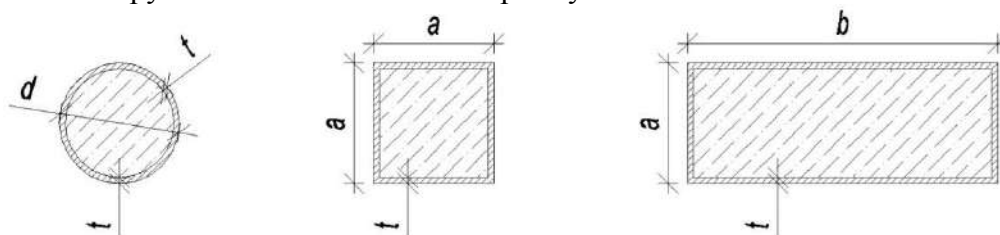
Поперечные сечения трубобетонных конструкций.
